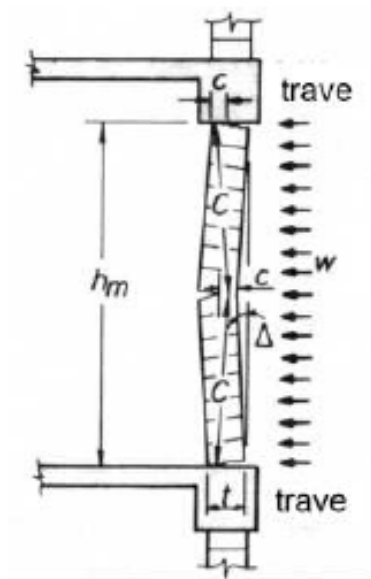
Schema di Applicazione dell'Azione Sismica al Tamponamento.
